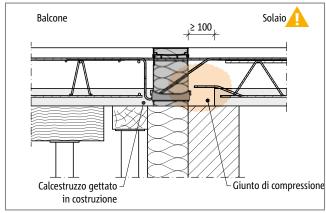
Schöck Isokorb $^{\circ}$ tipo KXT: appoggio diretto, montaggio con piastre prefabbricate (qui: h \leq 200 mm), giunto di compressione lato solaio
